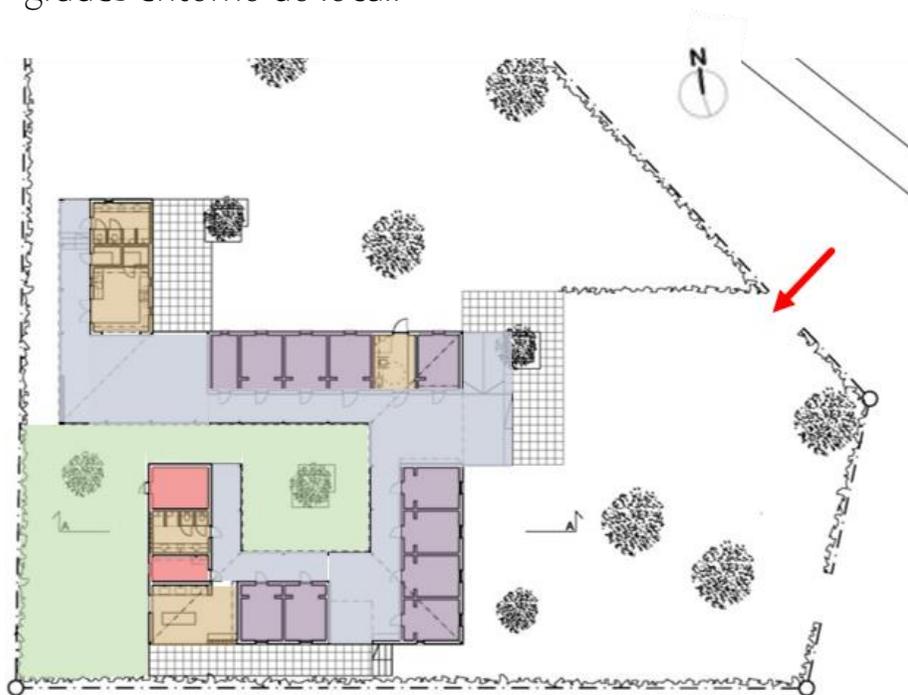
Planta baixa. Fonte: 2018, ArchDaily. Com alteração da aluna
